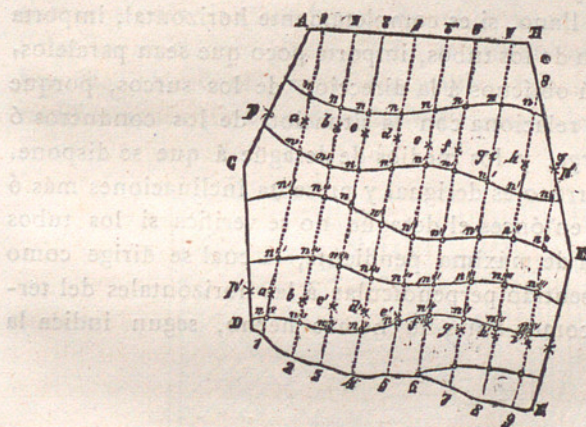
Levantamiento del plano y nivelacion de un terreno.
